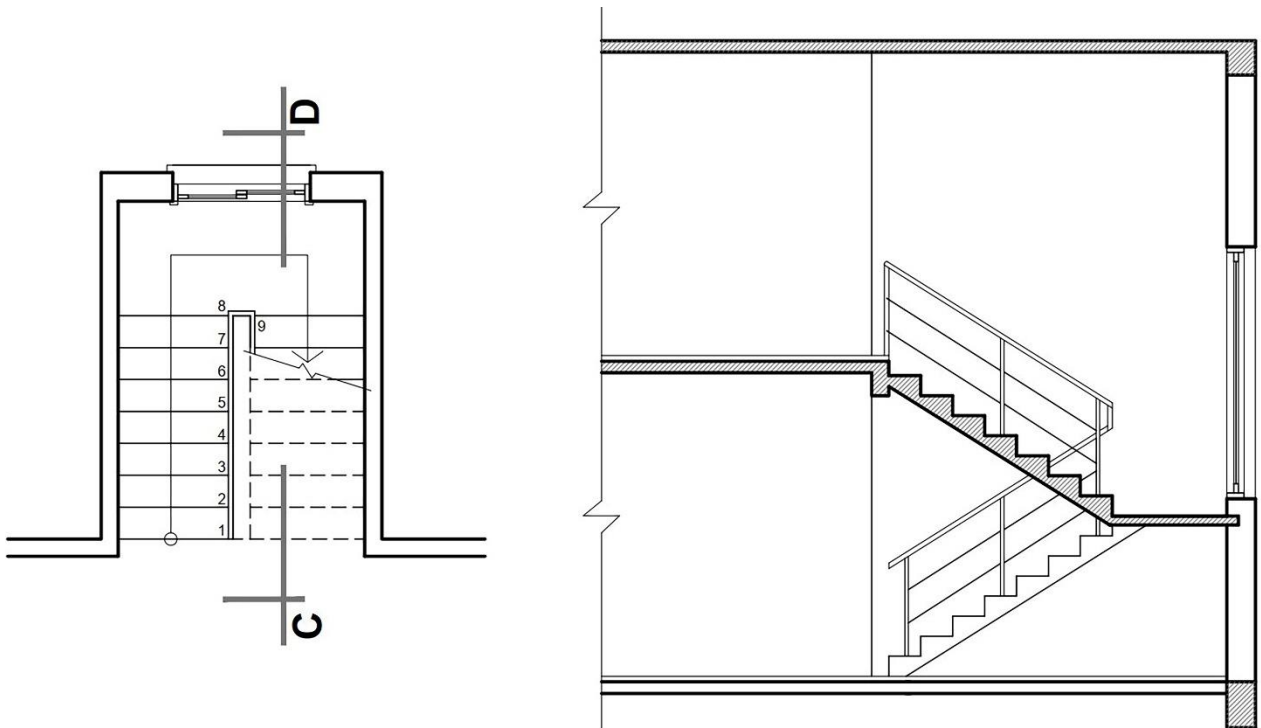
Alteração na posição do plano de corte: plano paralelo ao segundo lance.
